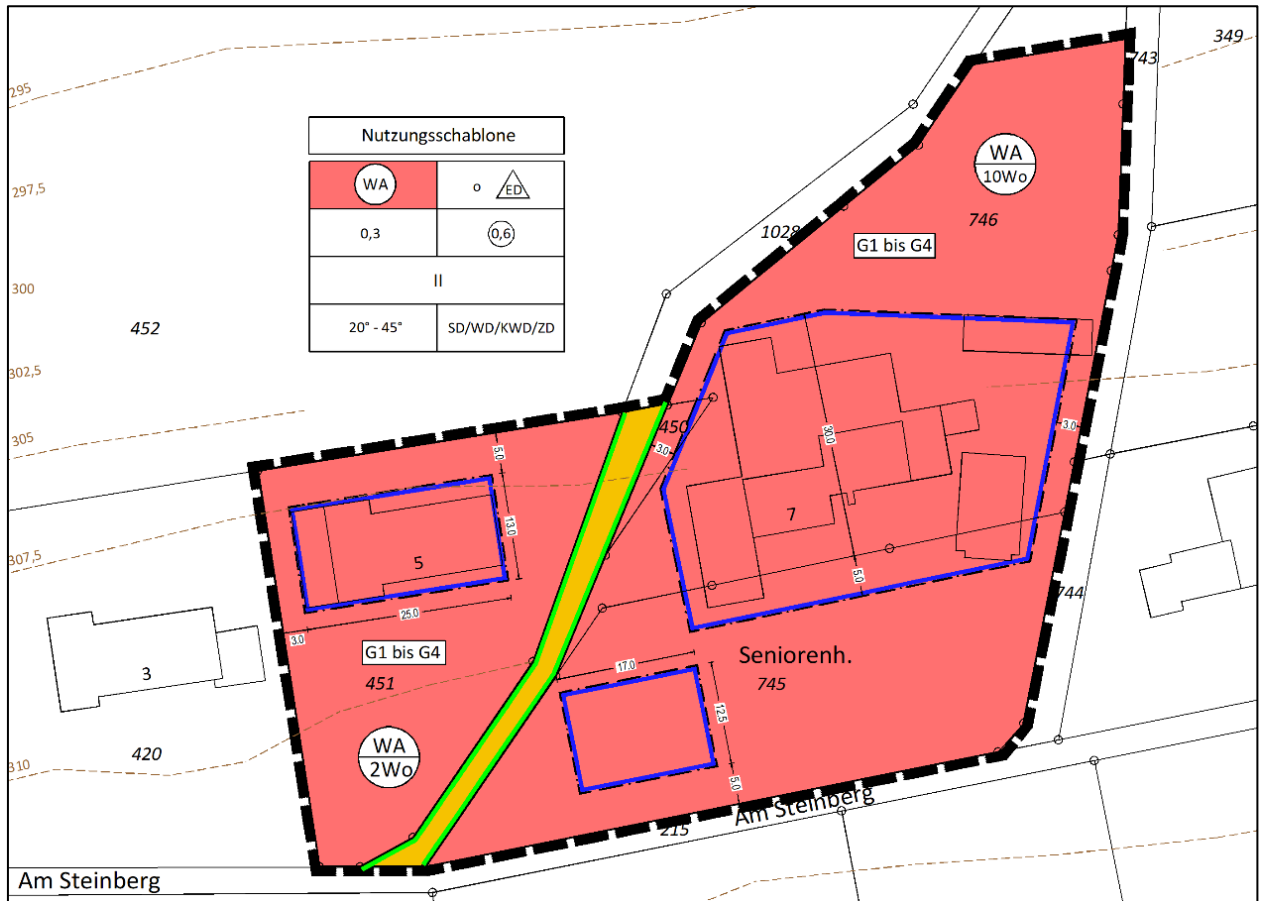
Planzeichnung Bebauungsplan (©HKS 2023)
